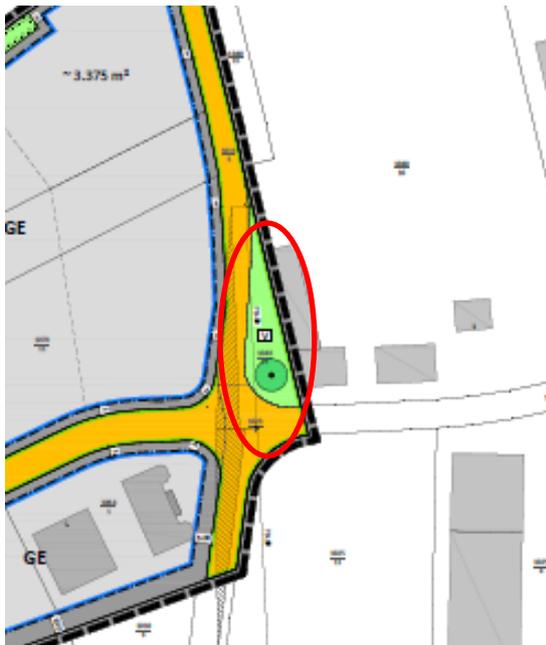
Ausschnitt, Bebauungsplan "Auf dem Hahn" 1. Teiländerung- und Erweiterung, Stand 2016
